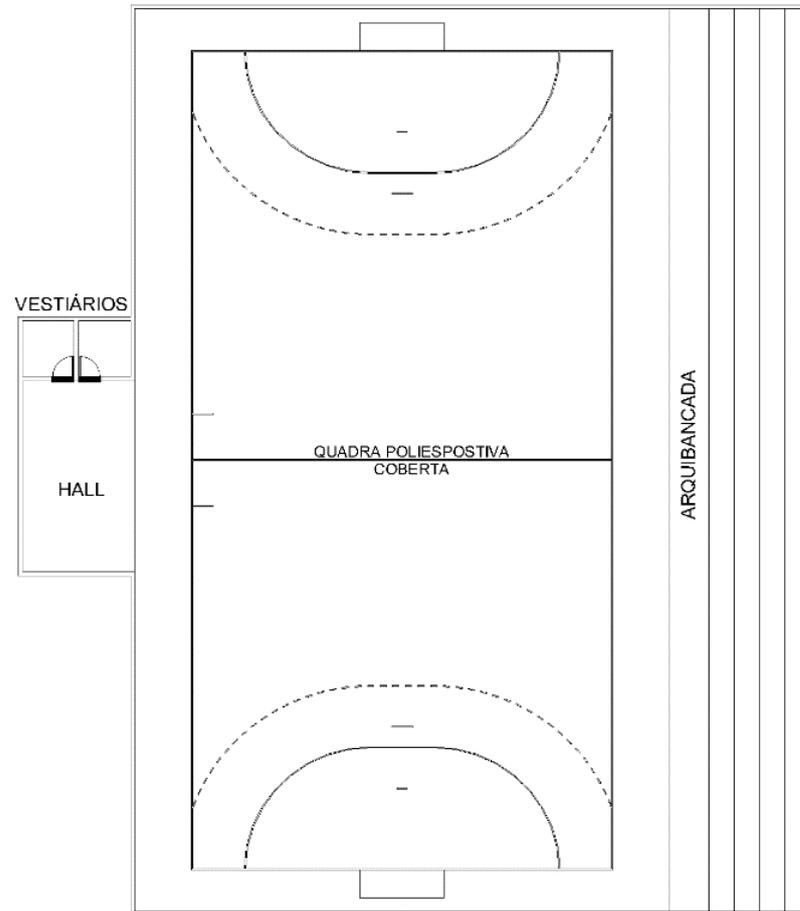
Planta de localização do Ginásio Poliesportivo Sesi-Tupaciguara
